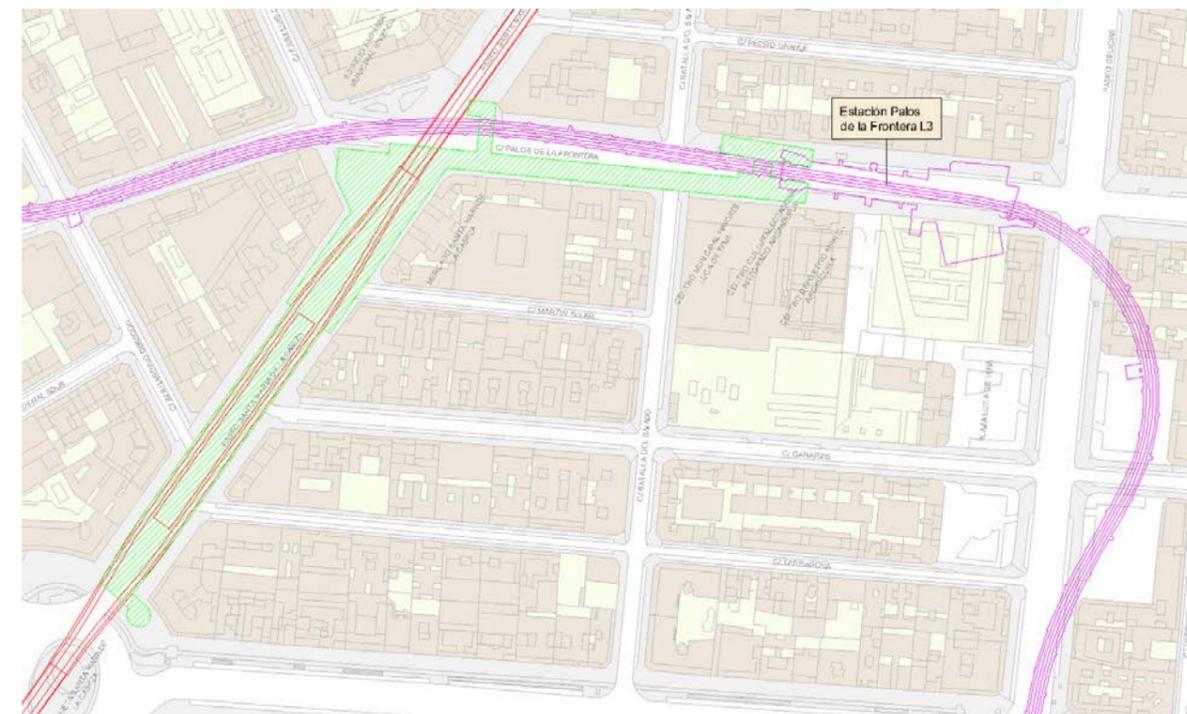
Planta de emplazamiento de la estación Palos de la Frontera L11, Alternativa 2
